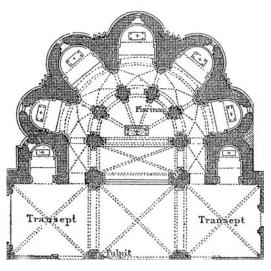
Veruela. Catedral, planta de la girola y crucero (Street [1865] 1926)
